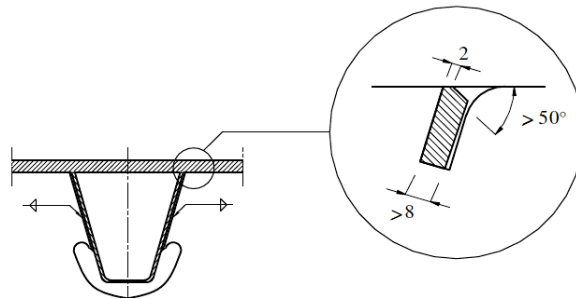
Підготовка під зварювання з'єднання «ребро жорсткості - плита мостового настилу»
